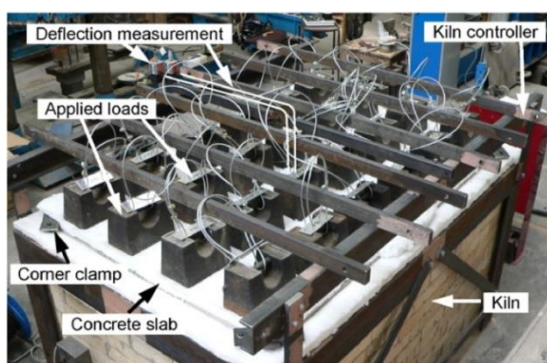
Ensaio para estudo da ação de membrana em lajes de concreto.
